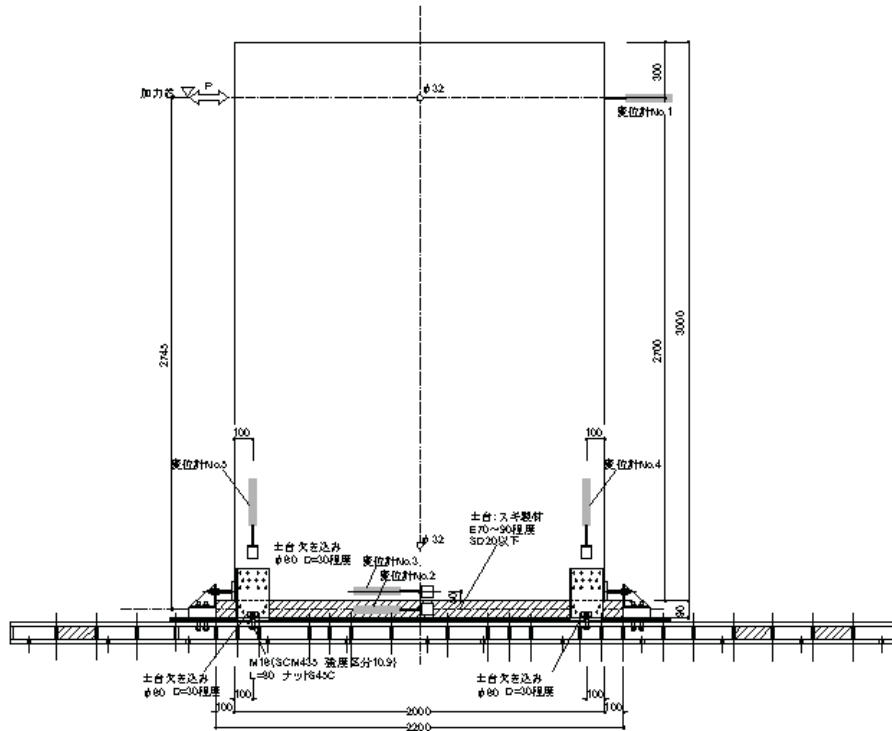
L型ビス用金物（2m幅耐力壁）試験体立面図(L2-1)
